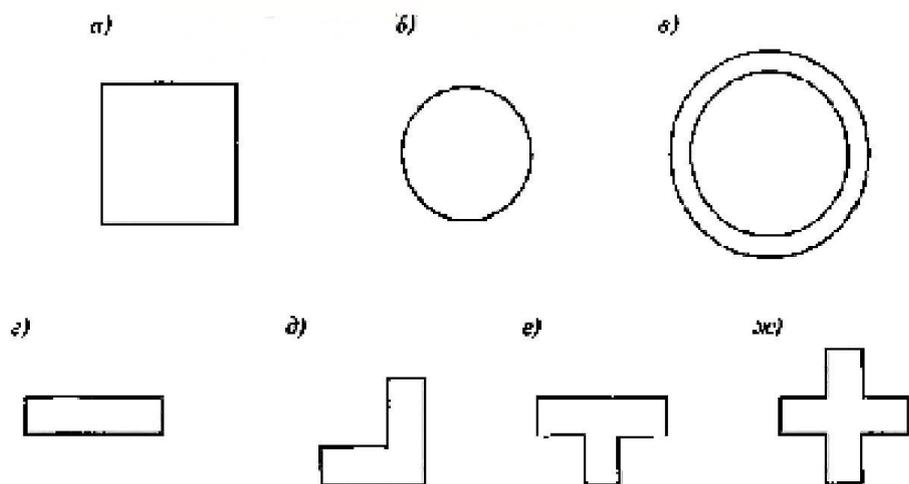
Поперечное сечение колонн: а) квадратное; б) круглое; в) кольцевое; г) прямоугольное; д) угловое; е) тавровое; ж) крестовое
